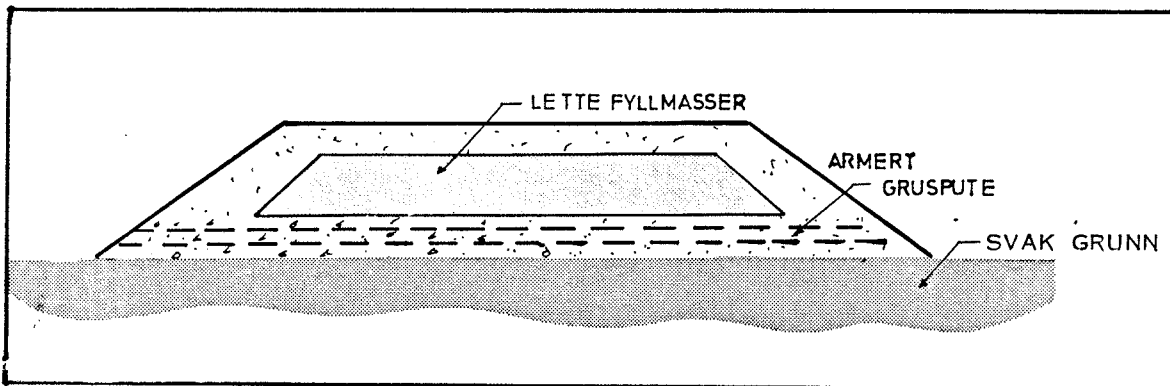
Armering av avrettingslag under skumplastfyllinger gir stabilt fundament.
